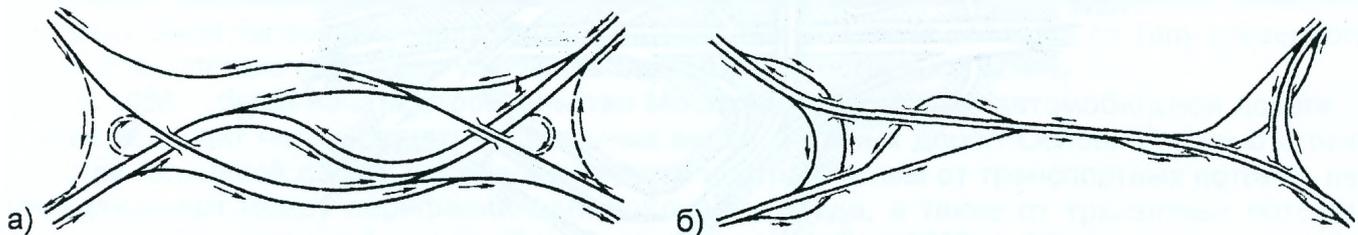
Схема линейного типа пересечений: а – с двумя путепроводами; б – с шестью путепроводами
